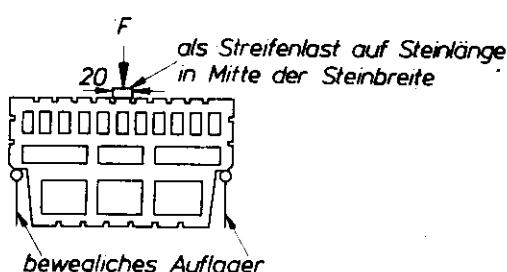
Prüfanordnung zur Bestimmung der Bruchlast
